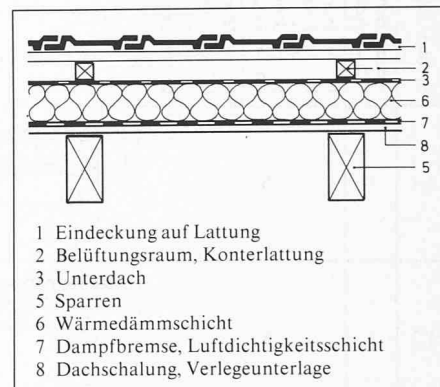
Neuere, konventionell über den Sparren wärmedämmte Steildachkonstruktion (Querschnitt)
